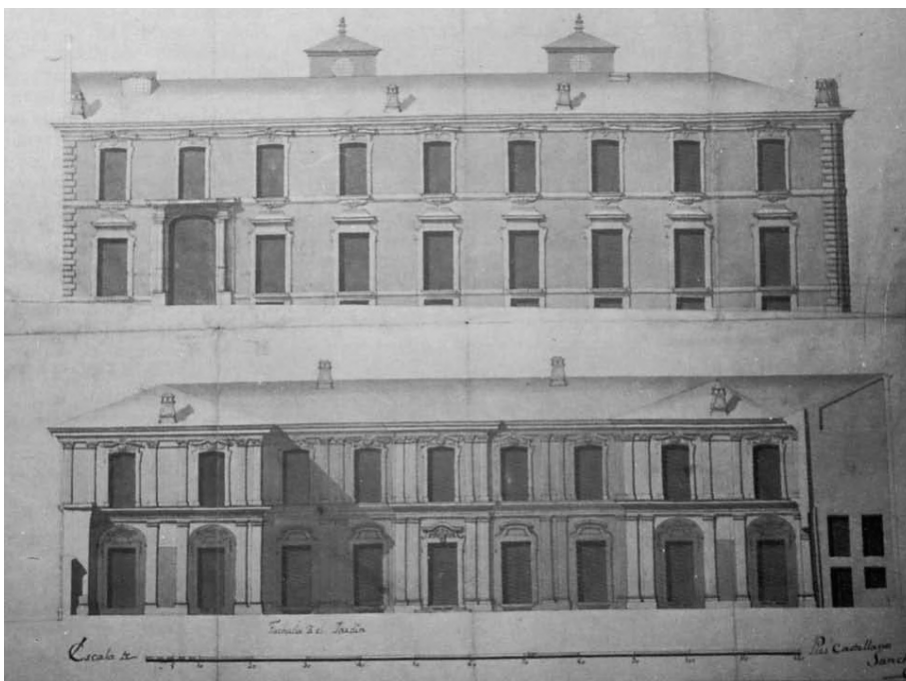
Francisco Sánchez: Alzados del Palacio de Alessandro Pico de la Mirandola. Arriba: fachada a la carrera de San Jerónimo. Abajo: fachada principal, al jardín. Archivo de Villanueva.
